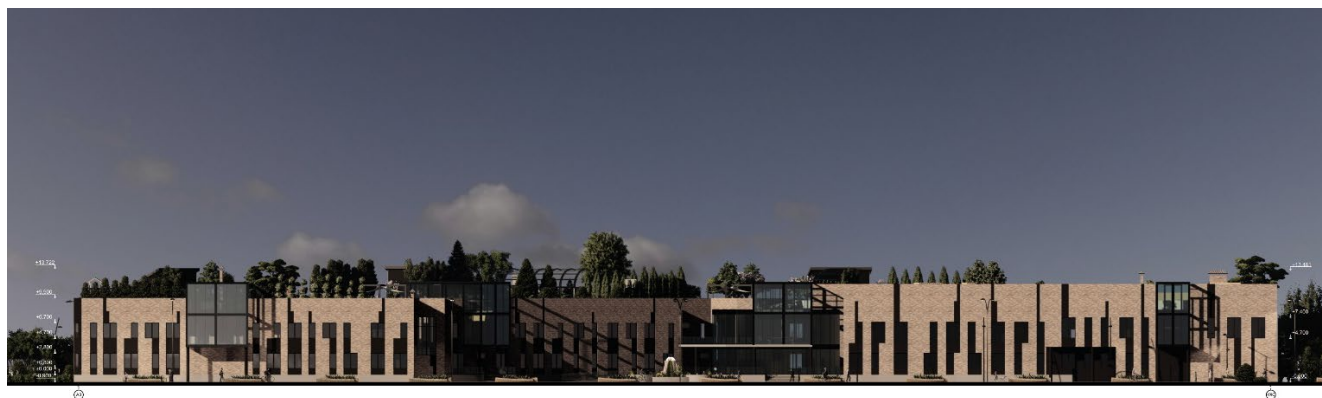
Фасад АЗ-ЖЖЗ
